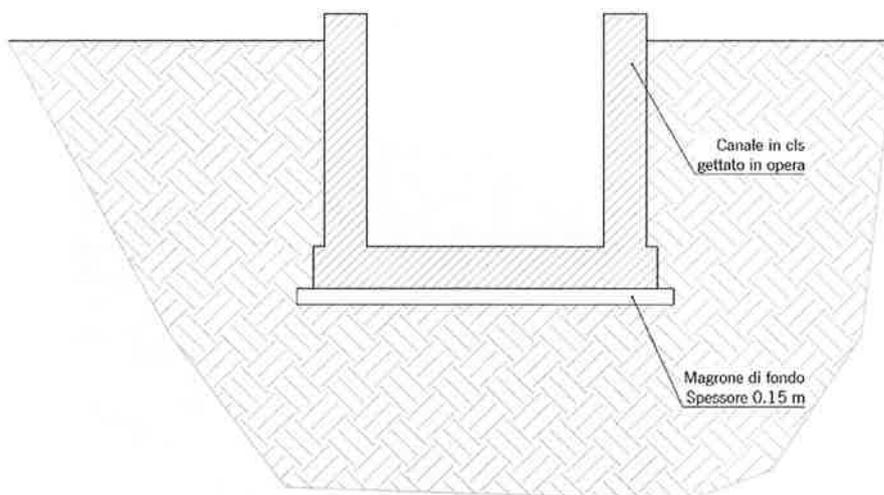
Inalveazione IN05 – canale di monte a sezione quadrata. Sezione tipologica
